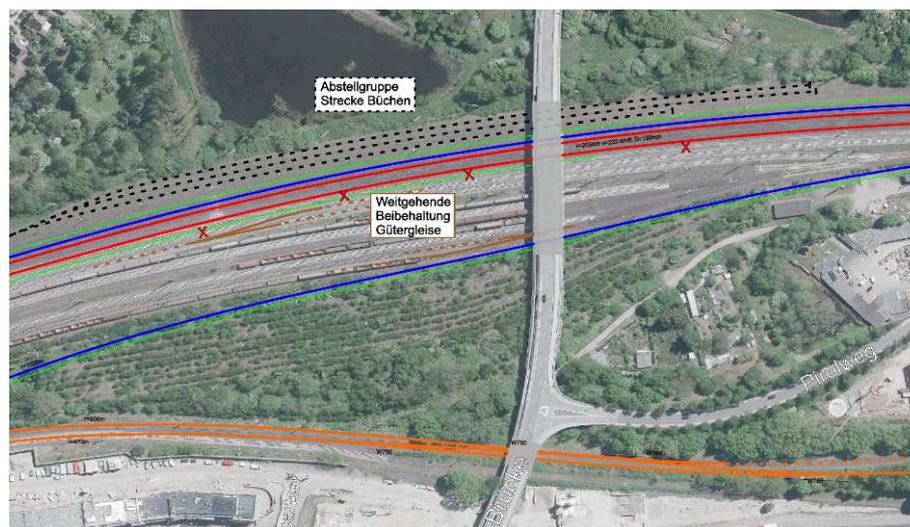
Ausschnitt aus dem Original VR Lageplan (Friedrich-Ebert-Brücke) für den südlichen Abschnitt mit Beibehaltung Güterbahnhof
